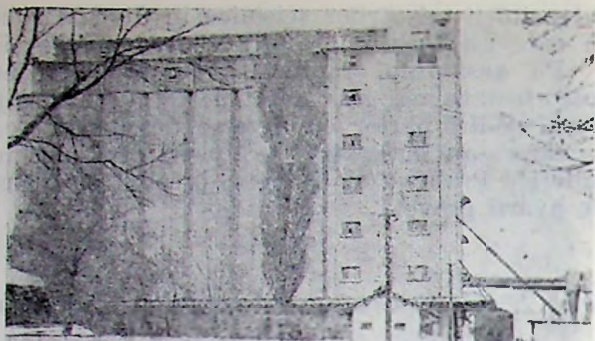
Silozuri vechi de cereale, tip monobloc, din beton armat monolit ($h = 22$ m), construite înainte de 1940.
